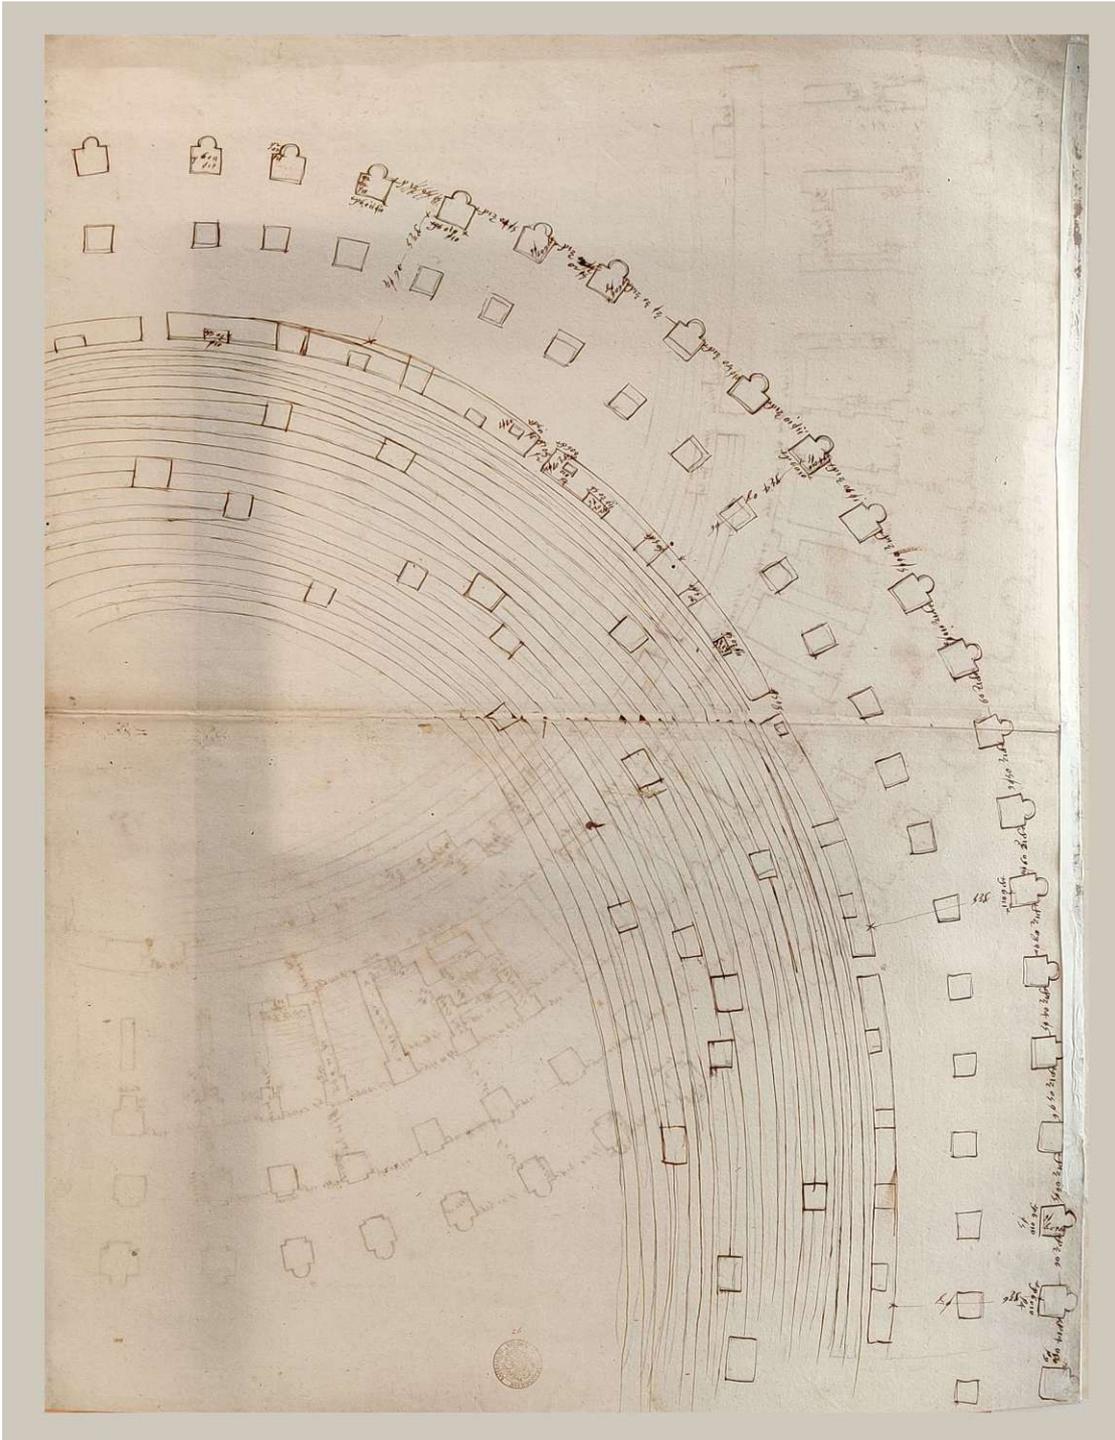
Verso: Kolosseum: Teilgrundriss des nordwestlichen Quadranten | 2. Obergeschoss
